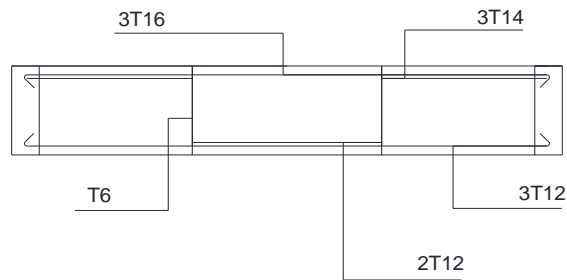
Coupe longitudinale d'une poutre principale 25x35cm (plancher au dalles pleines)
